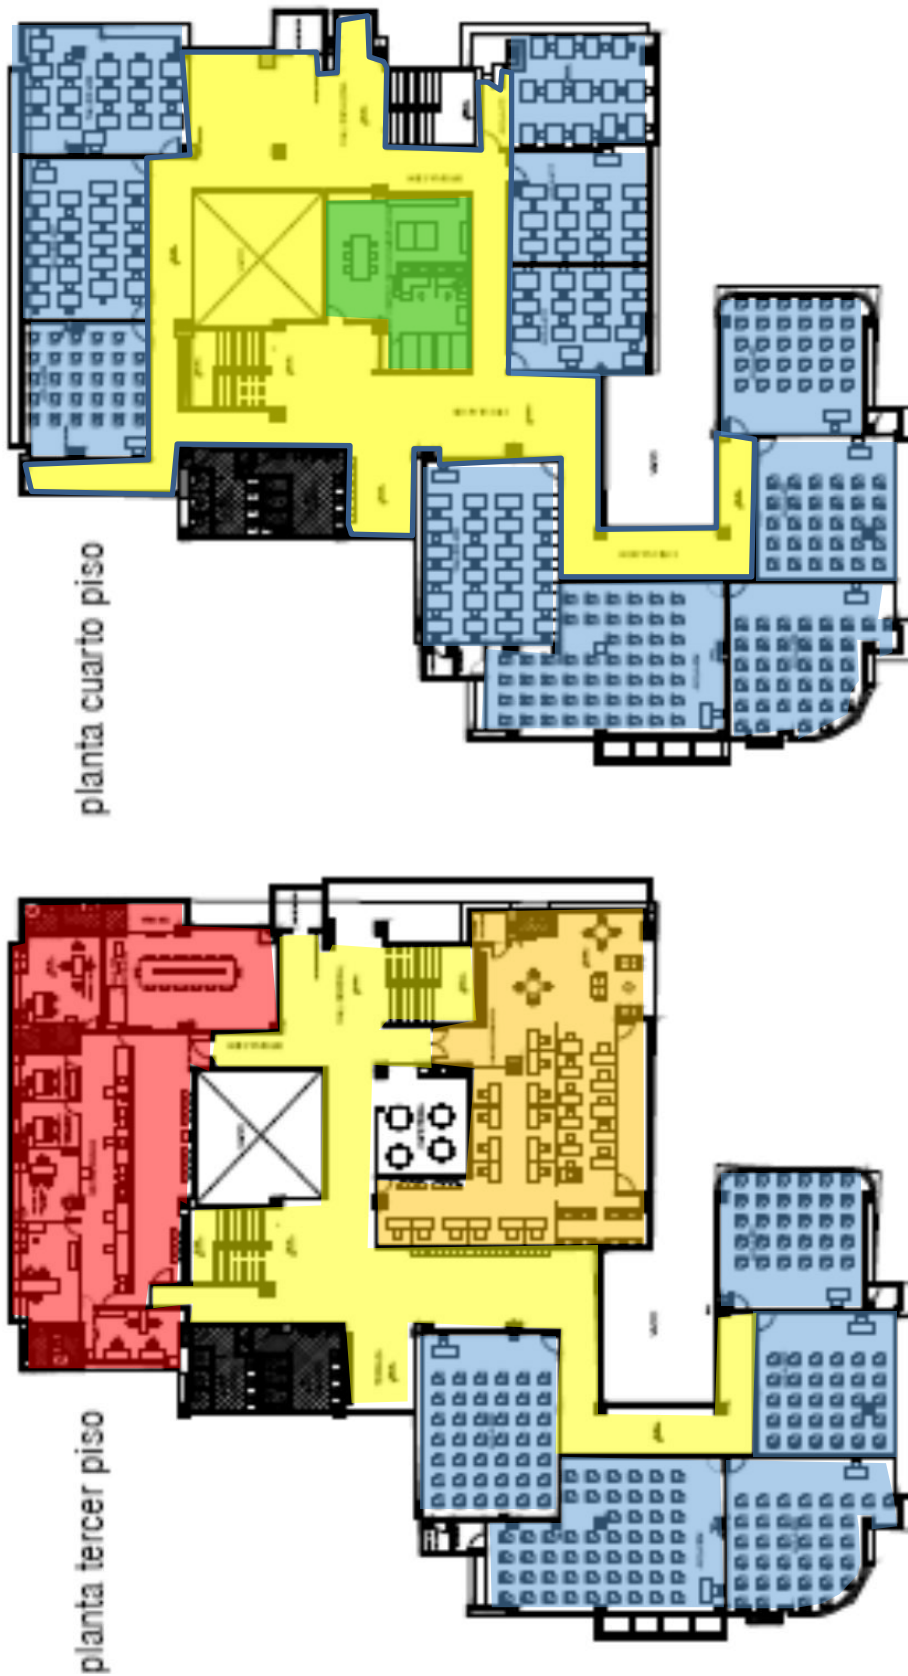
Planta tercer piso, planta cuarto piso. Amarillo: circulación publica, Azul: aulas teóricas y laboratorios, Naranja: sala de profesores, Rojo: oficinas de decanatura.
